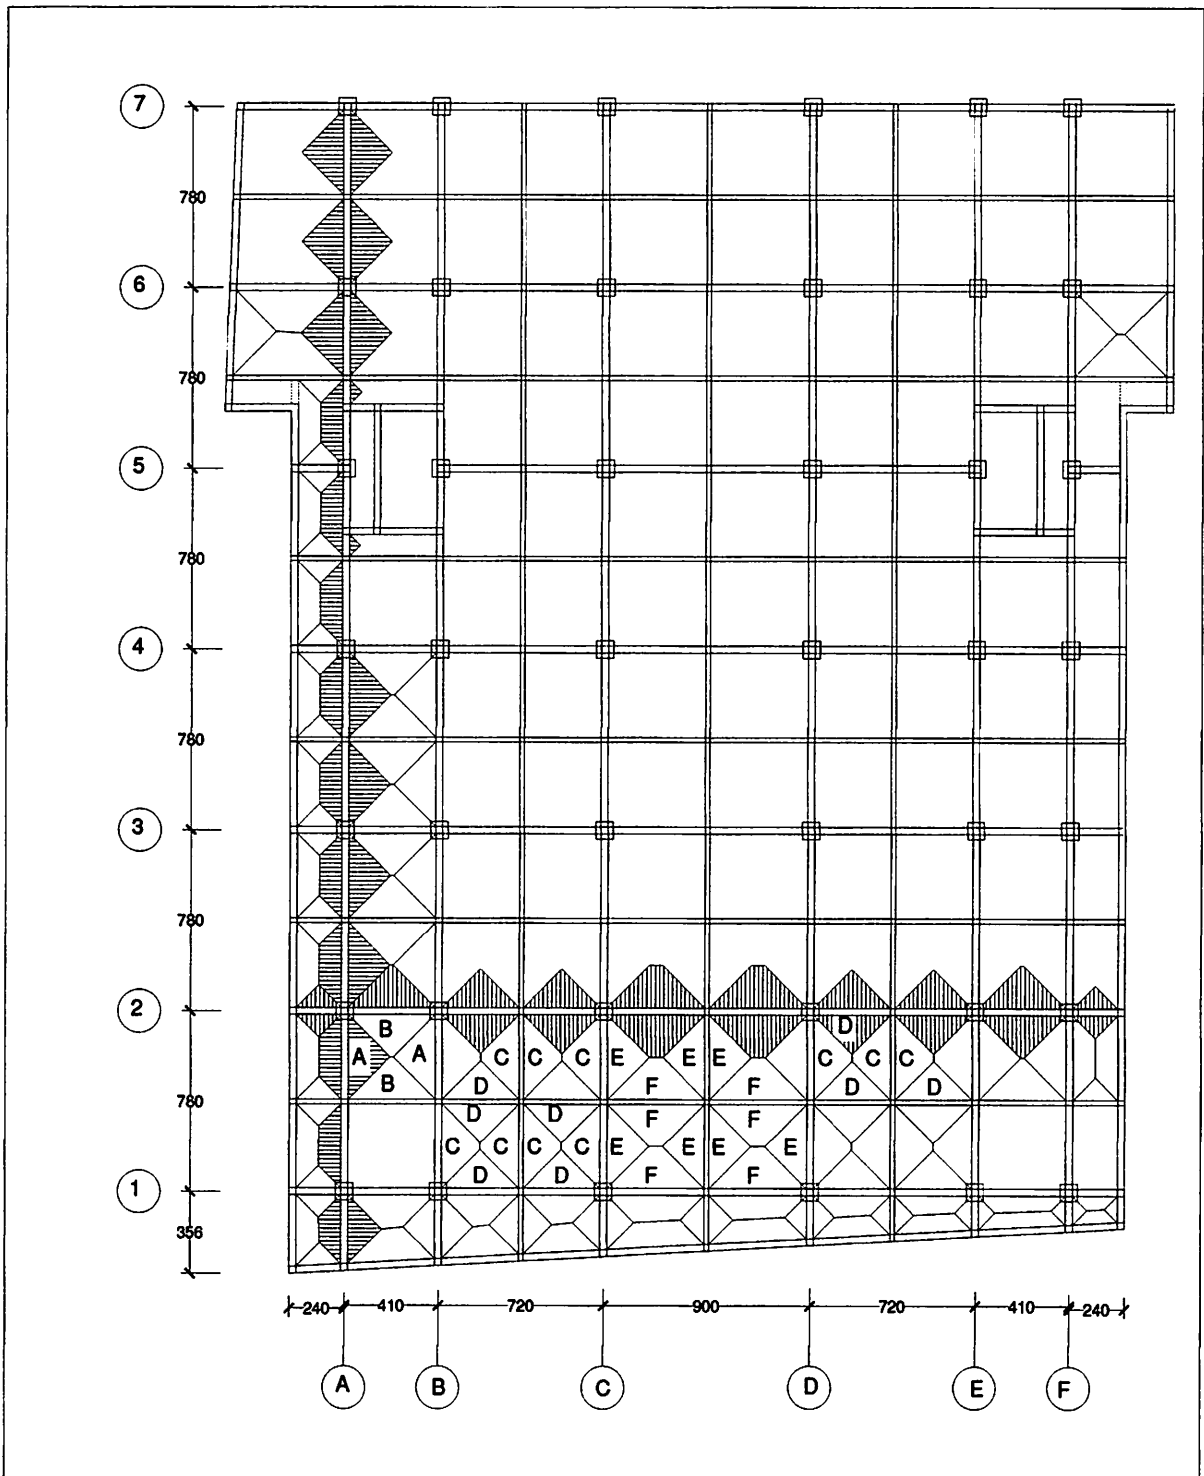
Balok Yang Terbebani Pelat Lantai 1
